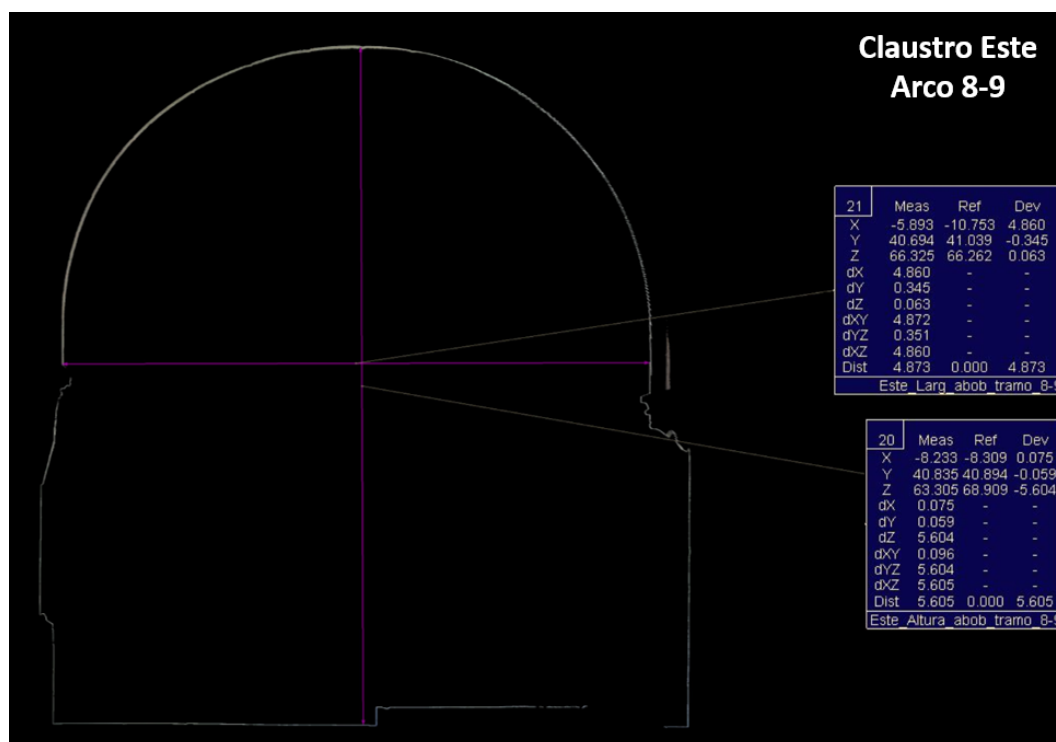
Corte transversal do Arco 8-9 do claustro Este de D. Dinis.
